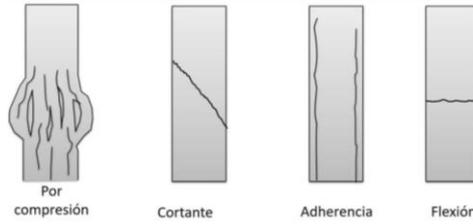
Tipo de falla en columnas de concreto armado [11]
